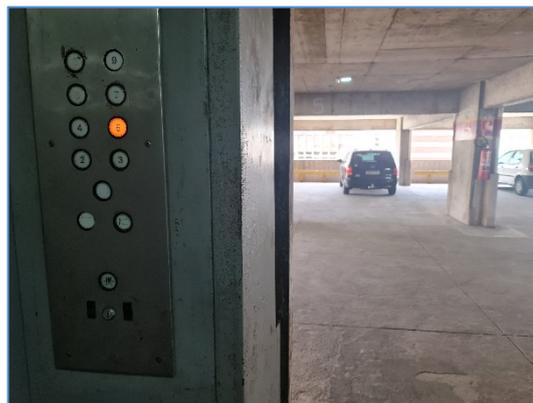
Elevador de carro de acesso aos pavimentos de garagem
